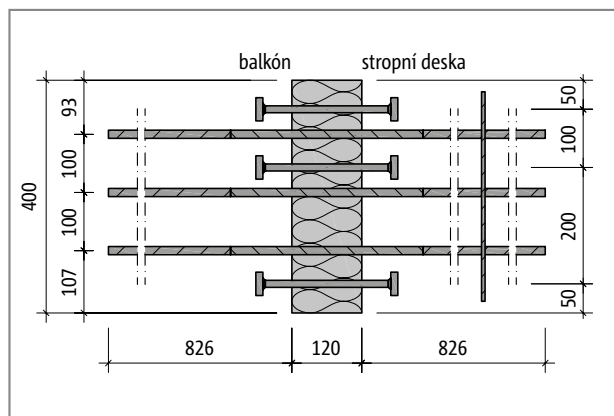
Schöck Isokorb® typ QPXT: Řez prvkem
